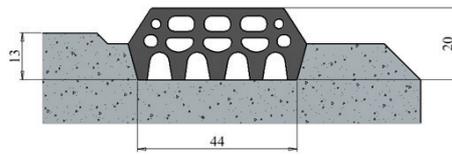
Guarnizione Sparvo e prova idraulica sulla stessa
